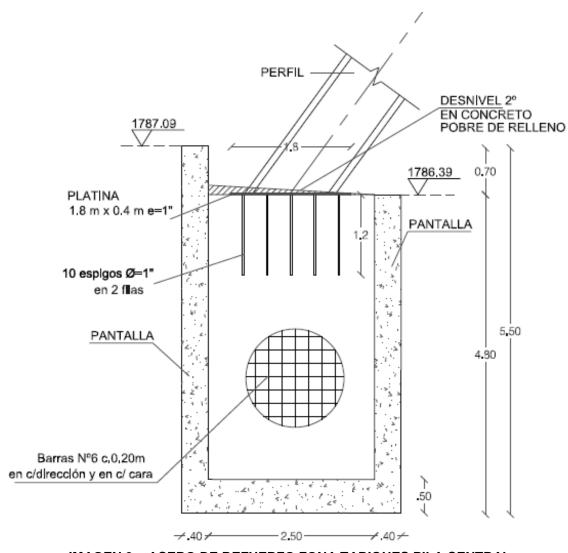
ACERO DE REFUERZO ZONA TABIQUES PILA CENTRAL
